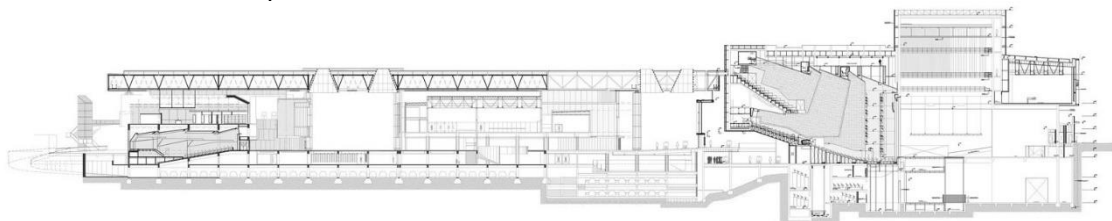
Corte arquitectónico del edificio, etapa 1.
